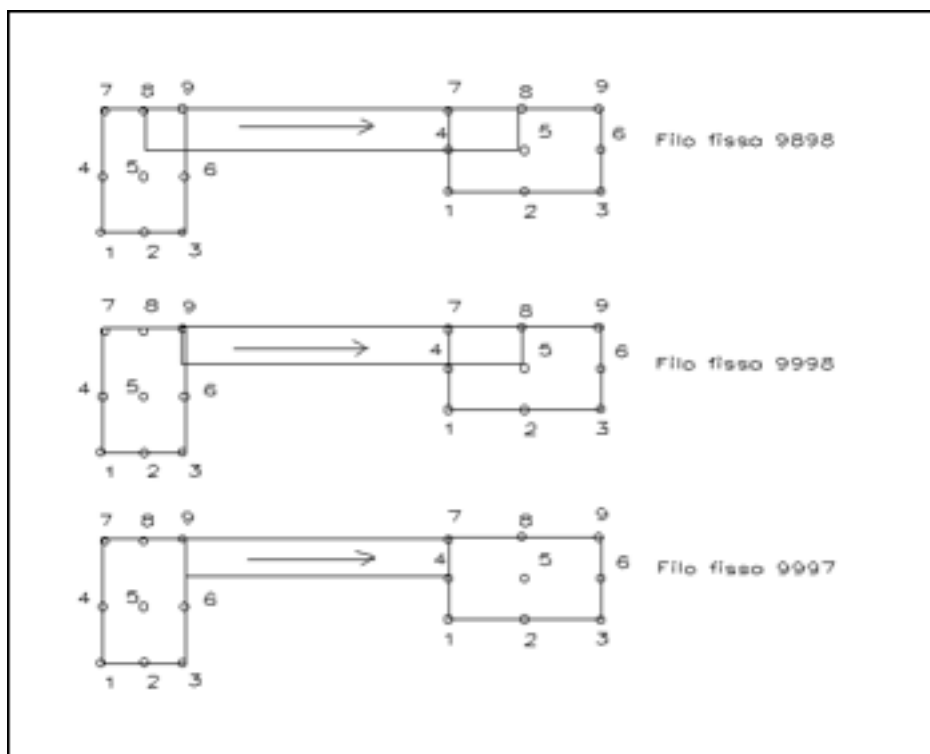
Configurazioni del filo fisso tra pilastri e travi
